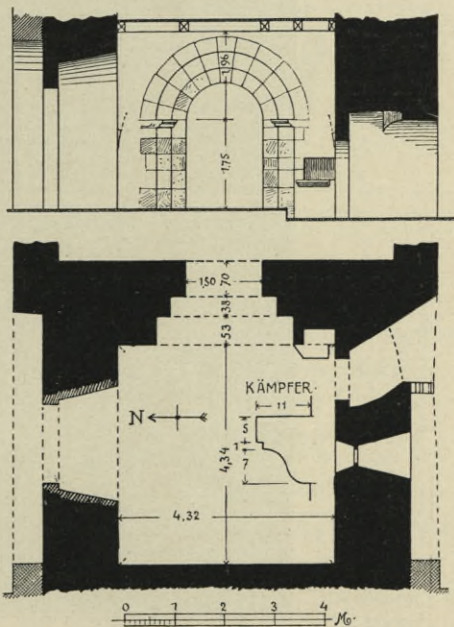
Zell a. Main. Oberzell. Obergeschoß der Vorhalle der Klosterkirche. Grundriß und Aufriß.
